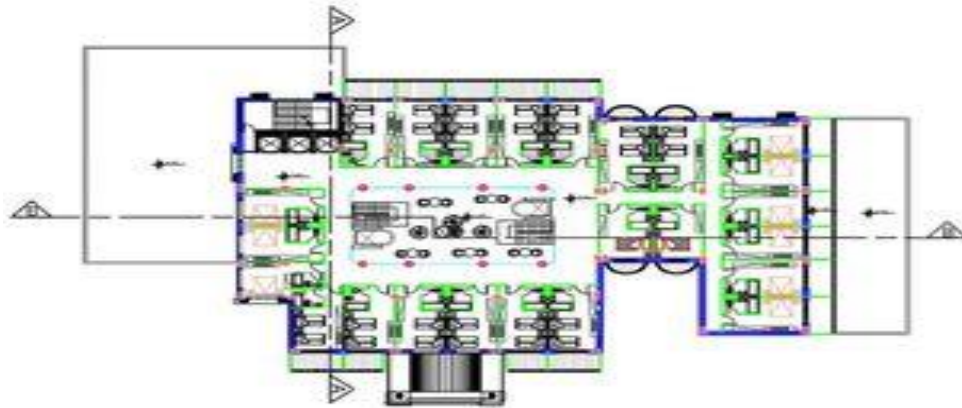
المسقط الأفقي للطابق الرابع .
